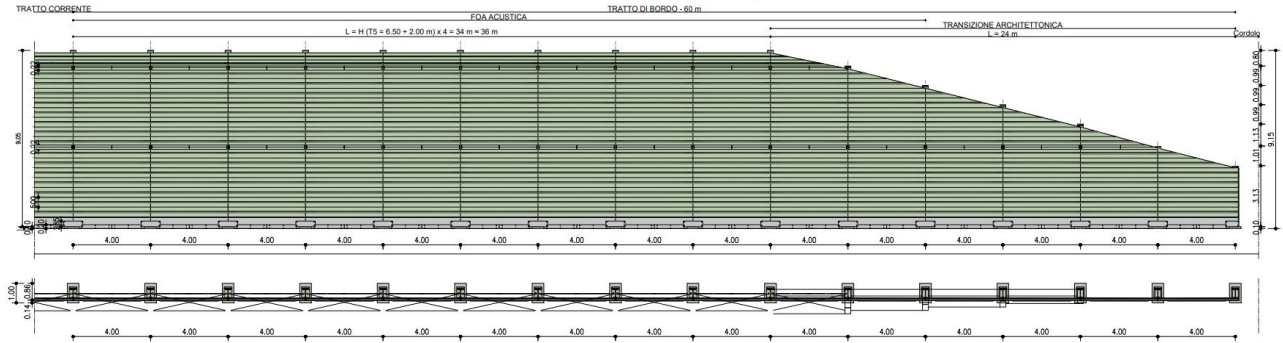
Barriera Tipo 3 - H=6,50m + 2,00m – Transizione
